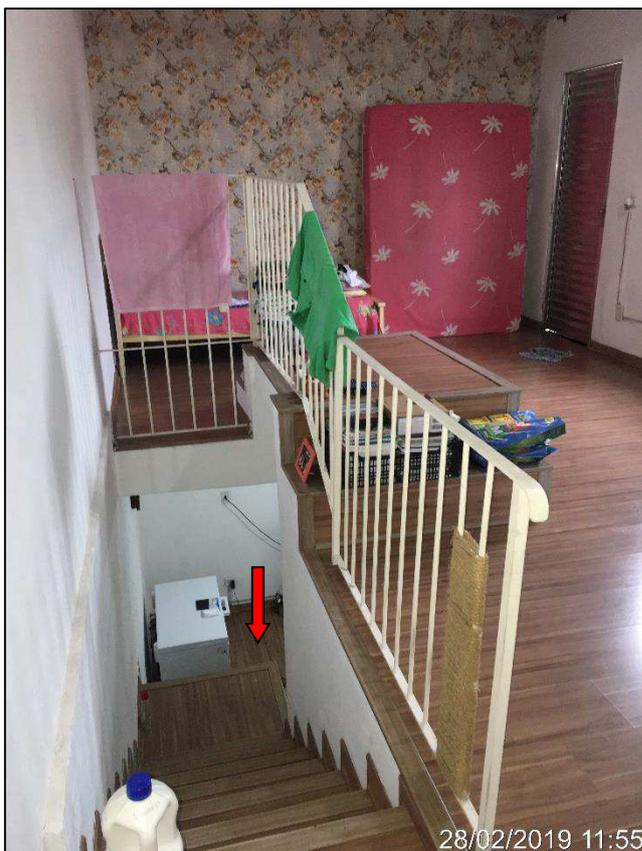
Vista da escada de acesso ao pavimento superior (destacada) e vista parcial do dormitório.
